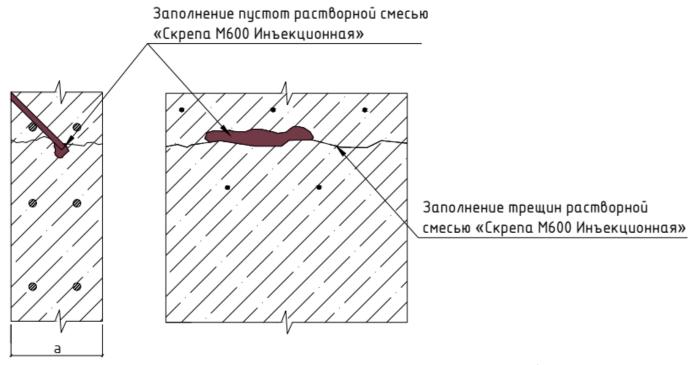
Схема заполнения пустот и трещин в монолитной бетонной стене
